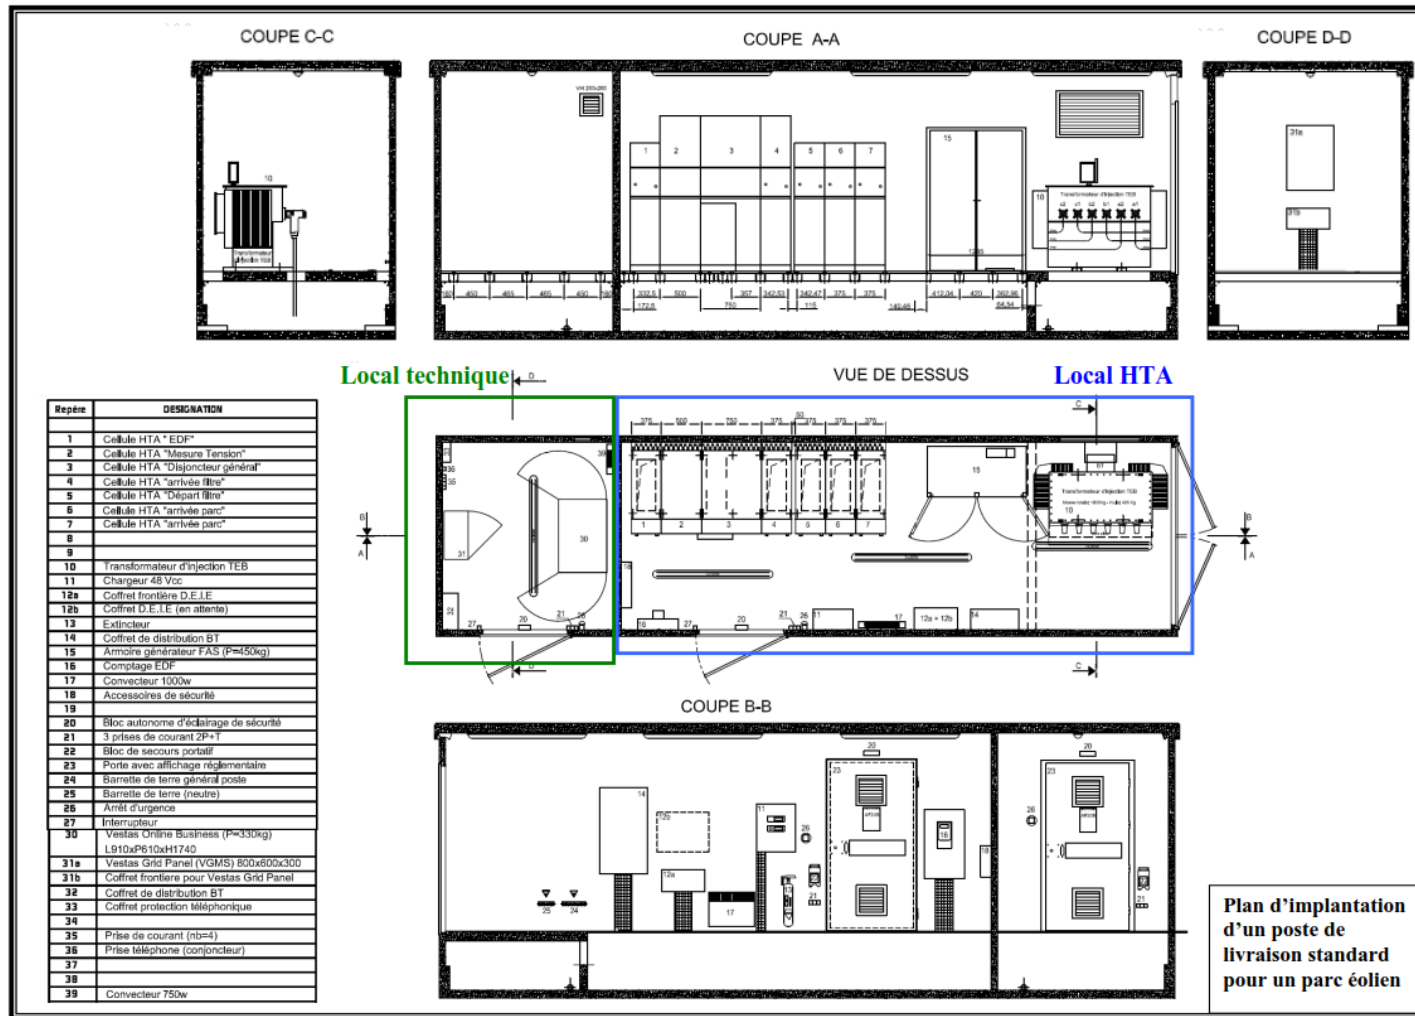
EXEMPLE D'UN PLAN D'UN POSTE DE LIVRAISON
